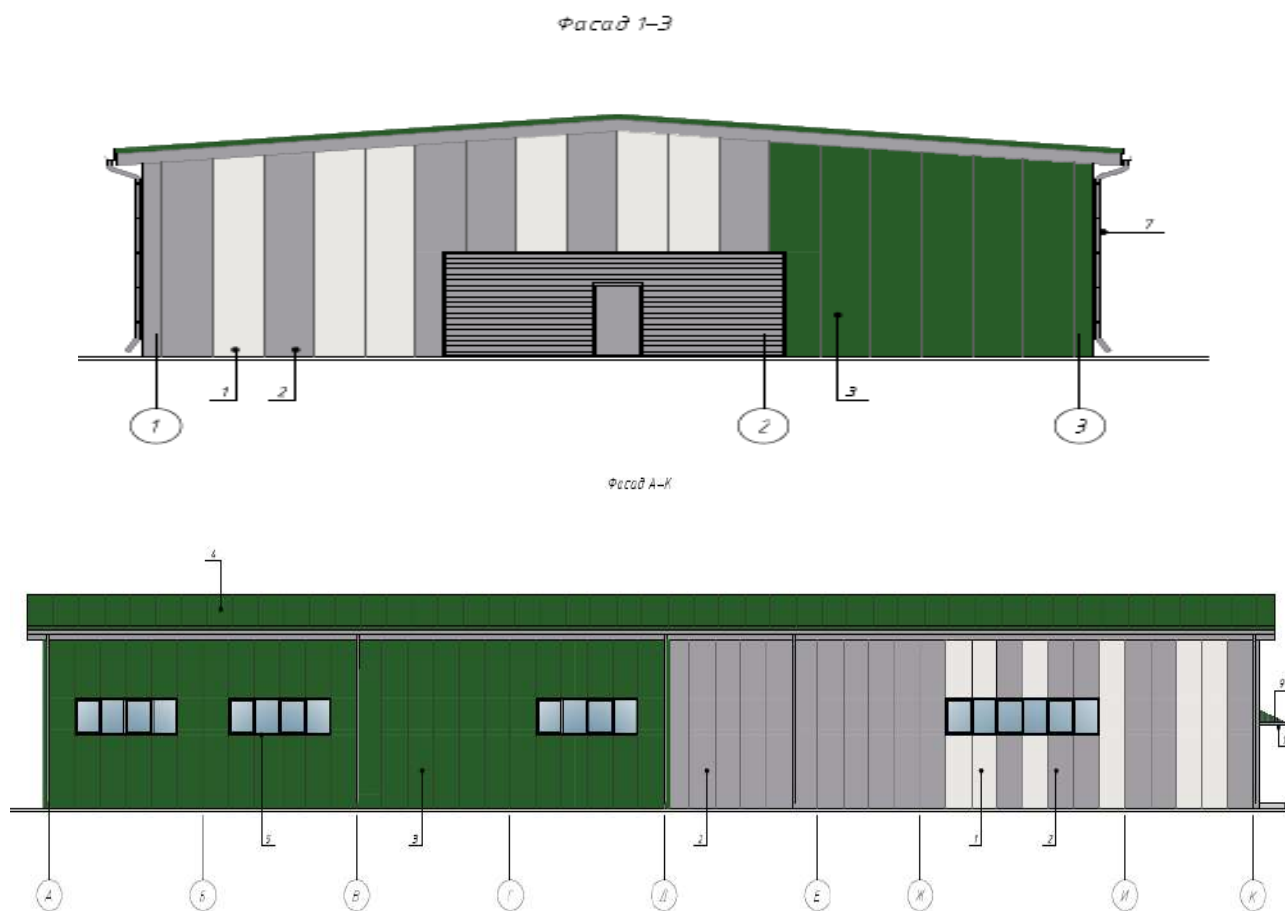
Схема фасадов погонажного цеха (по ГП №2)
